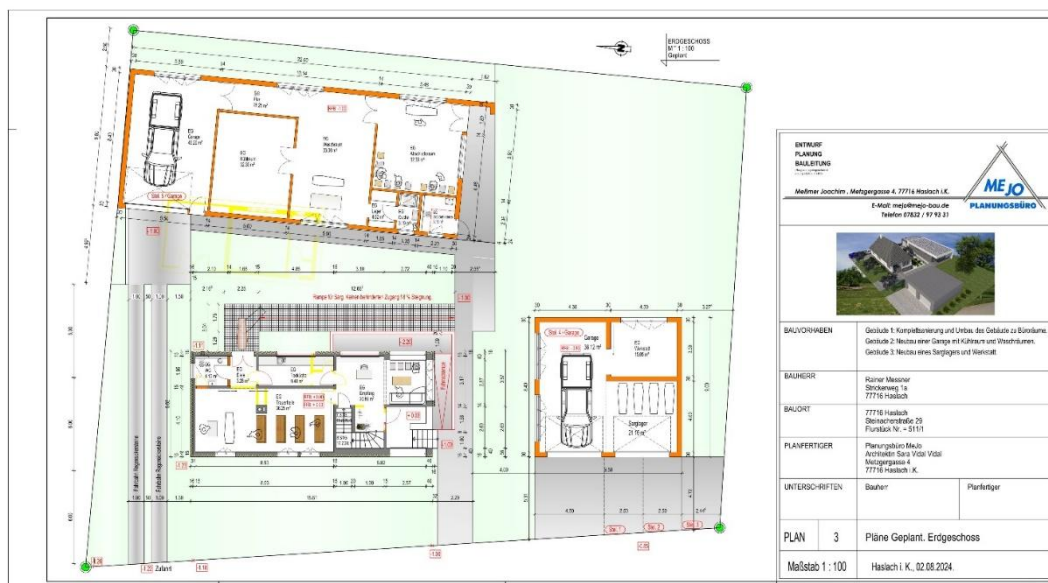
Entwurf Lageplan Planung (Planungsbüro MeJo, Stand 02.08.2024)
